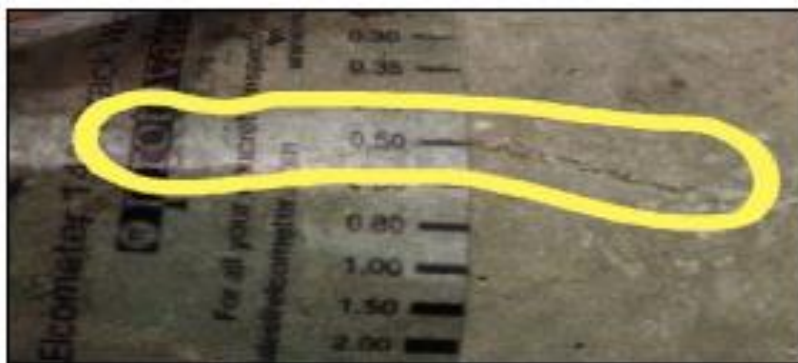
En el día 56 está grieta midió 0.50 mm de ancho.
